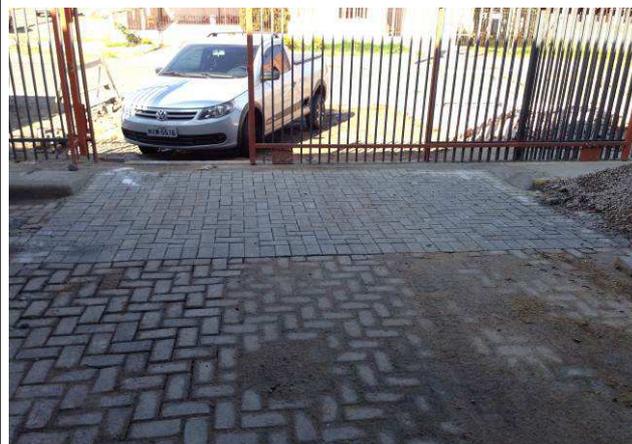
C: Pavimentação com blocos de concreto em área de acesso de veículos.
